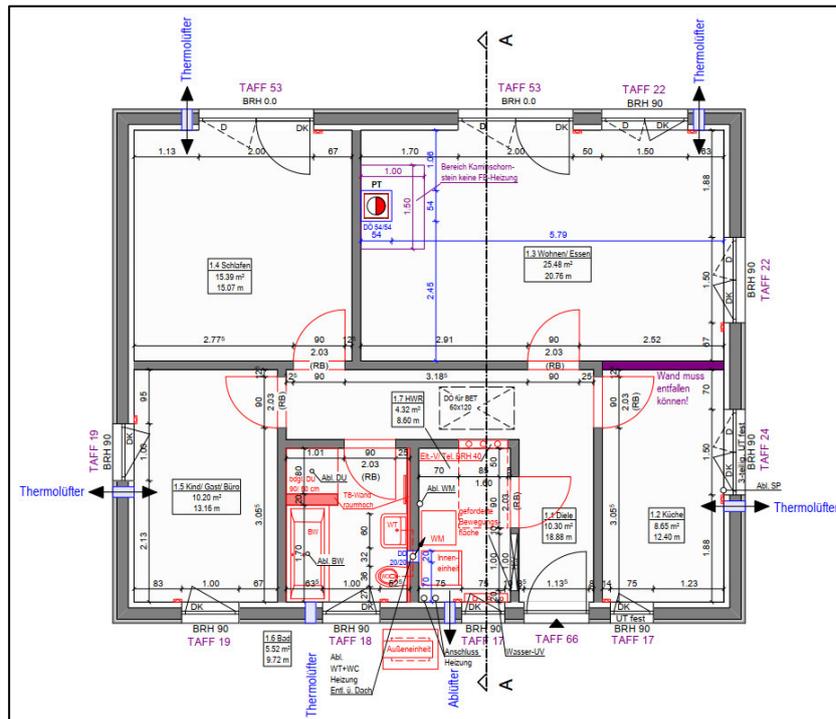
Grundriss Bungalow B80 (Annahme: Eingang Südfassade)
